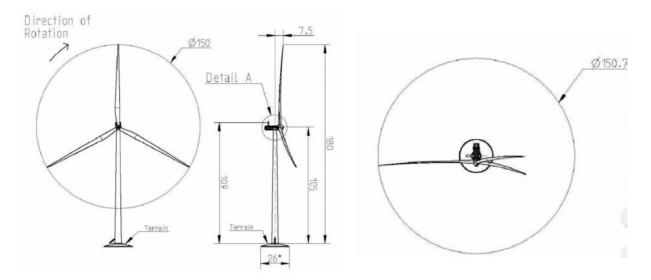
Vista prospettica, laterale e dall'alto dell'aerogeneratore VESTAS V-150 da 5,6 MW in progetto.
